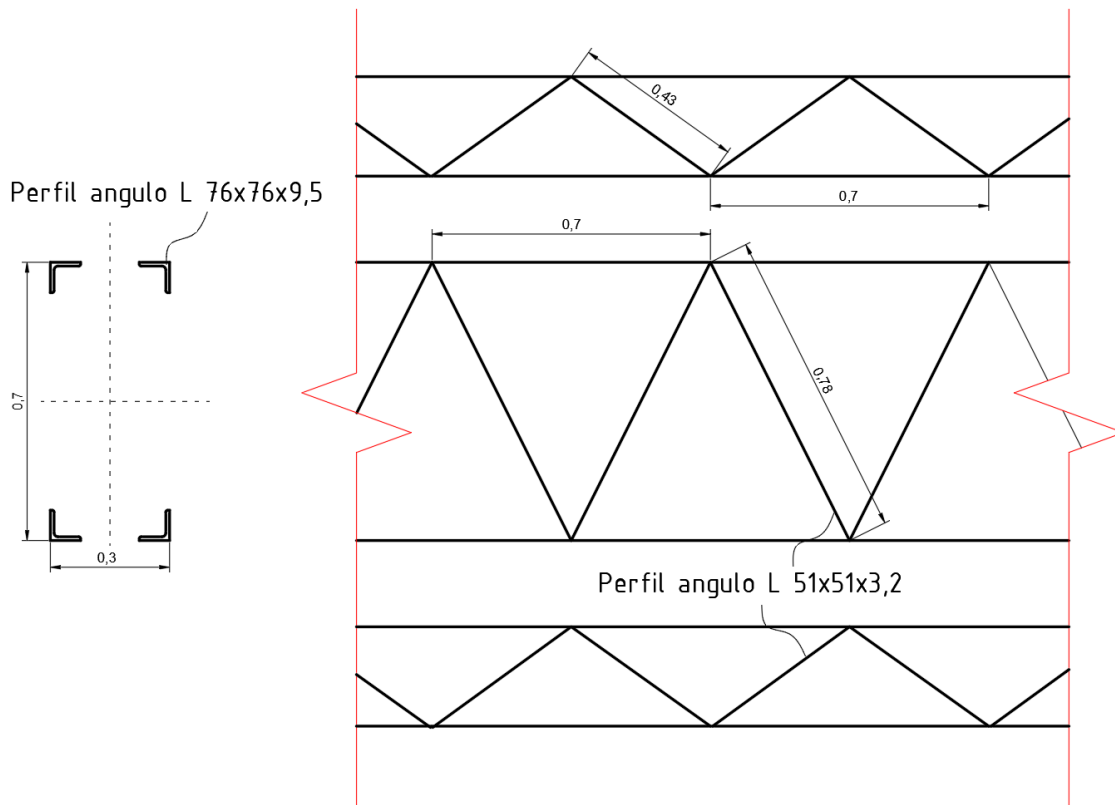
Predimensión de la sección de la viga metálica del pórtico
